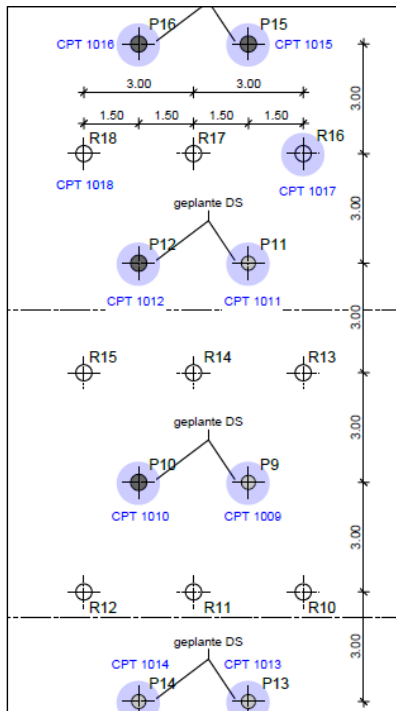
Lageplan Drucksondierungen Testfeld 3 – Heide 2
